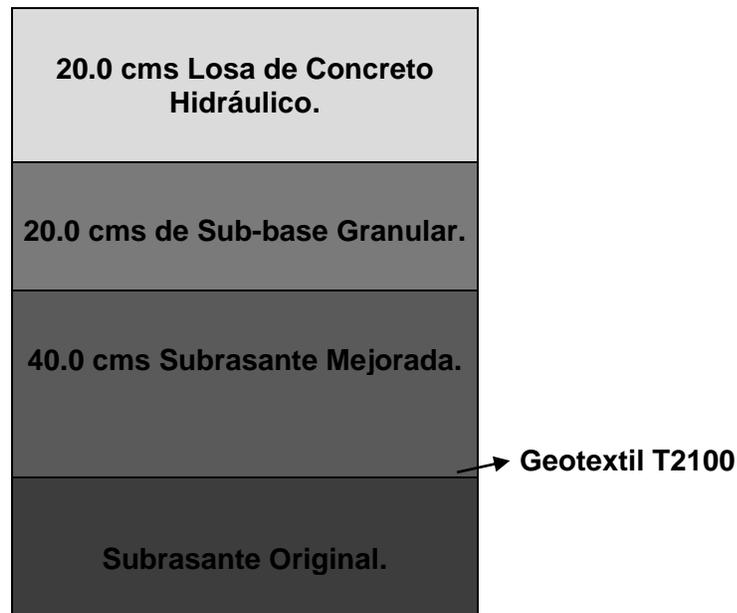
Solución de diseño de pavimento rígido para la vía calle 5 norte.
